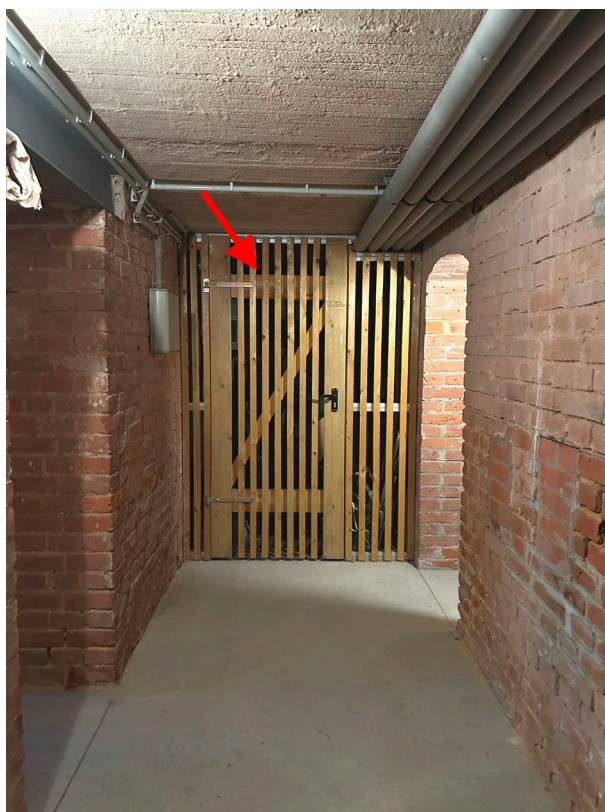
Kellergeschoss, Ansicht Zugangstür zu Keller Nr. 4
